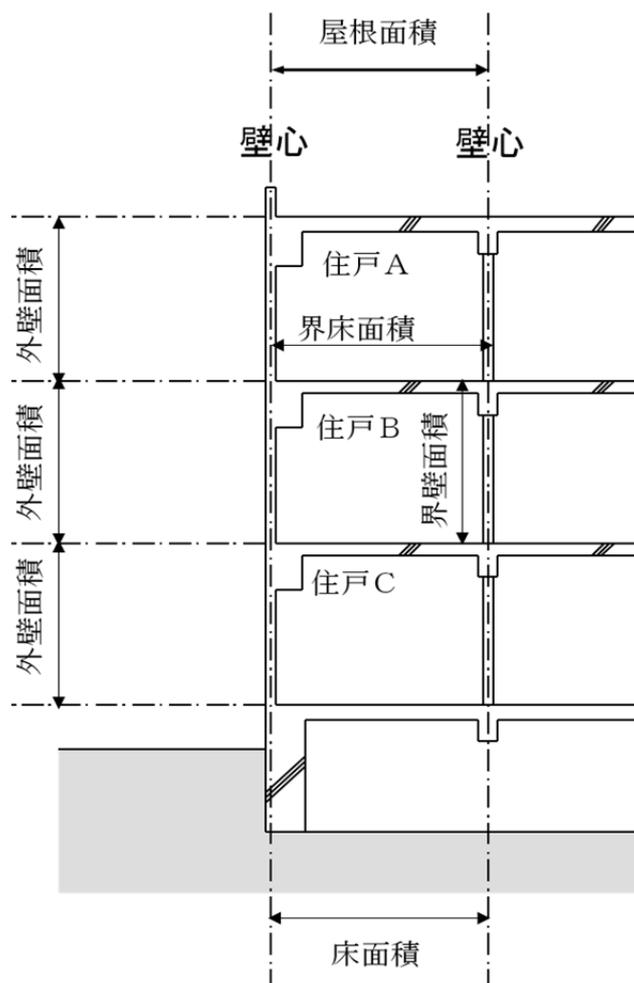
高さ寸法算定の考え方（鉄筋コンクリート造）
